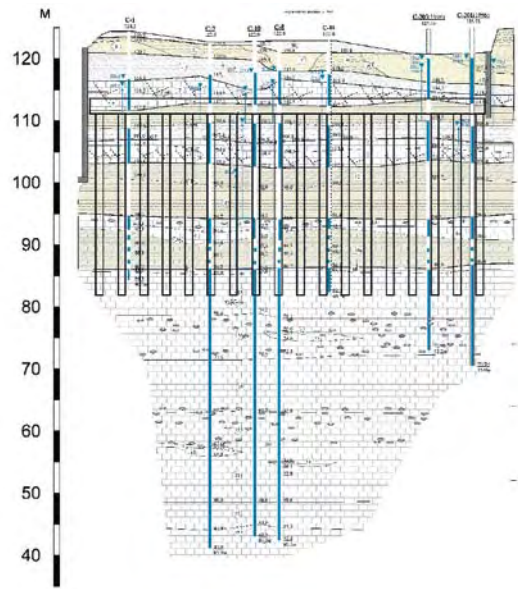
Характерный инженерно-геологический разрез грунтового основания, совмещенный со схемой фундамента и ограждения котлована
